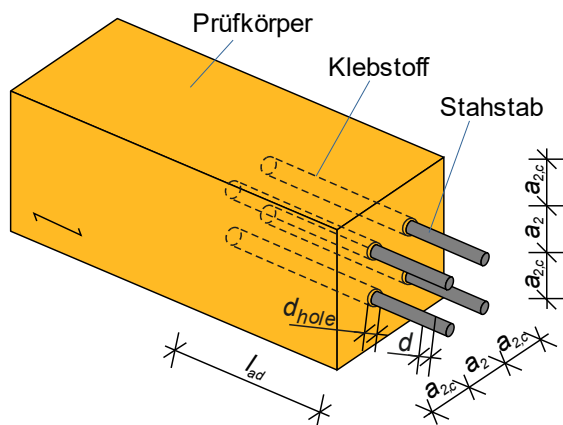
Prinzipskizze zu 2x2 Gewindestangengruppe, parallel zur Faserrichtung
